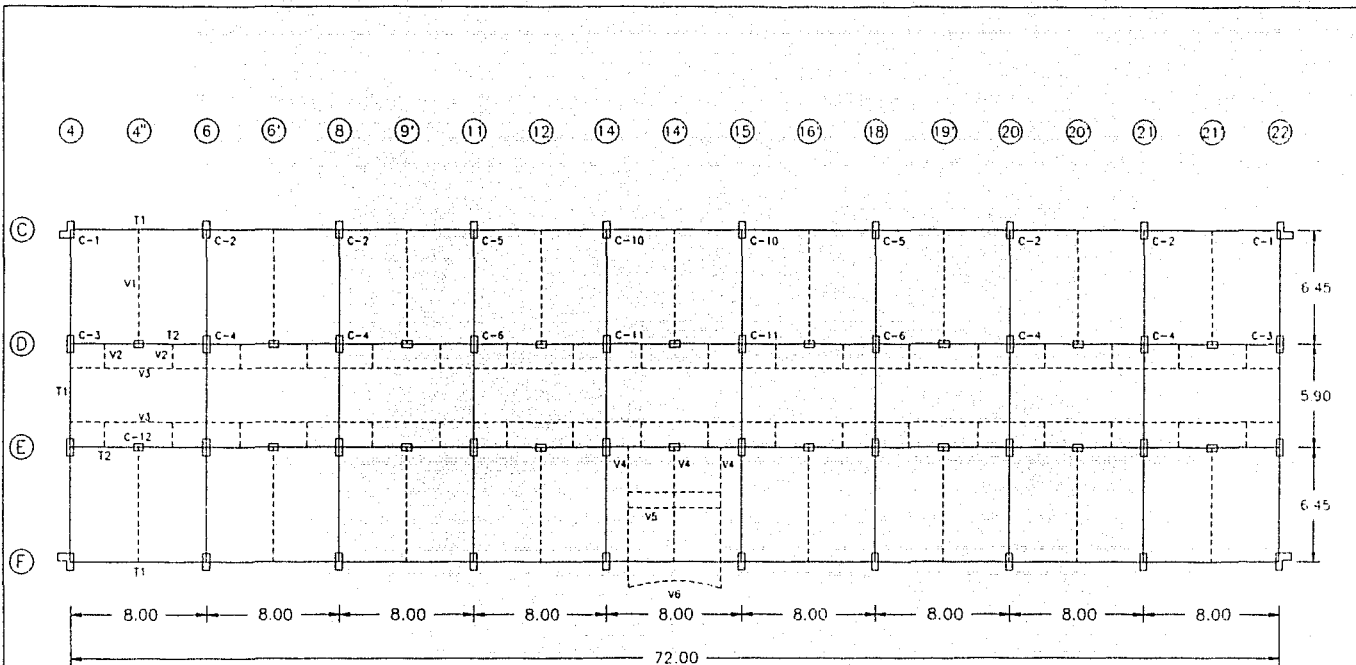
Planta Tipo (Niveles N-2 a N-7).
